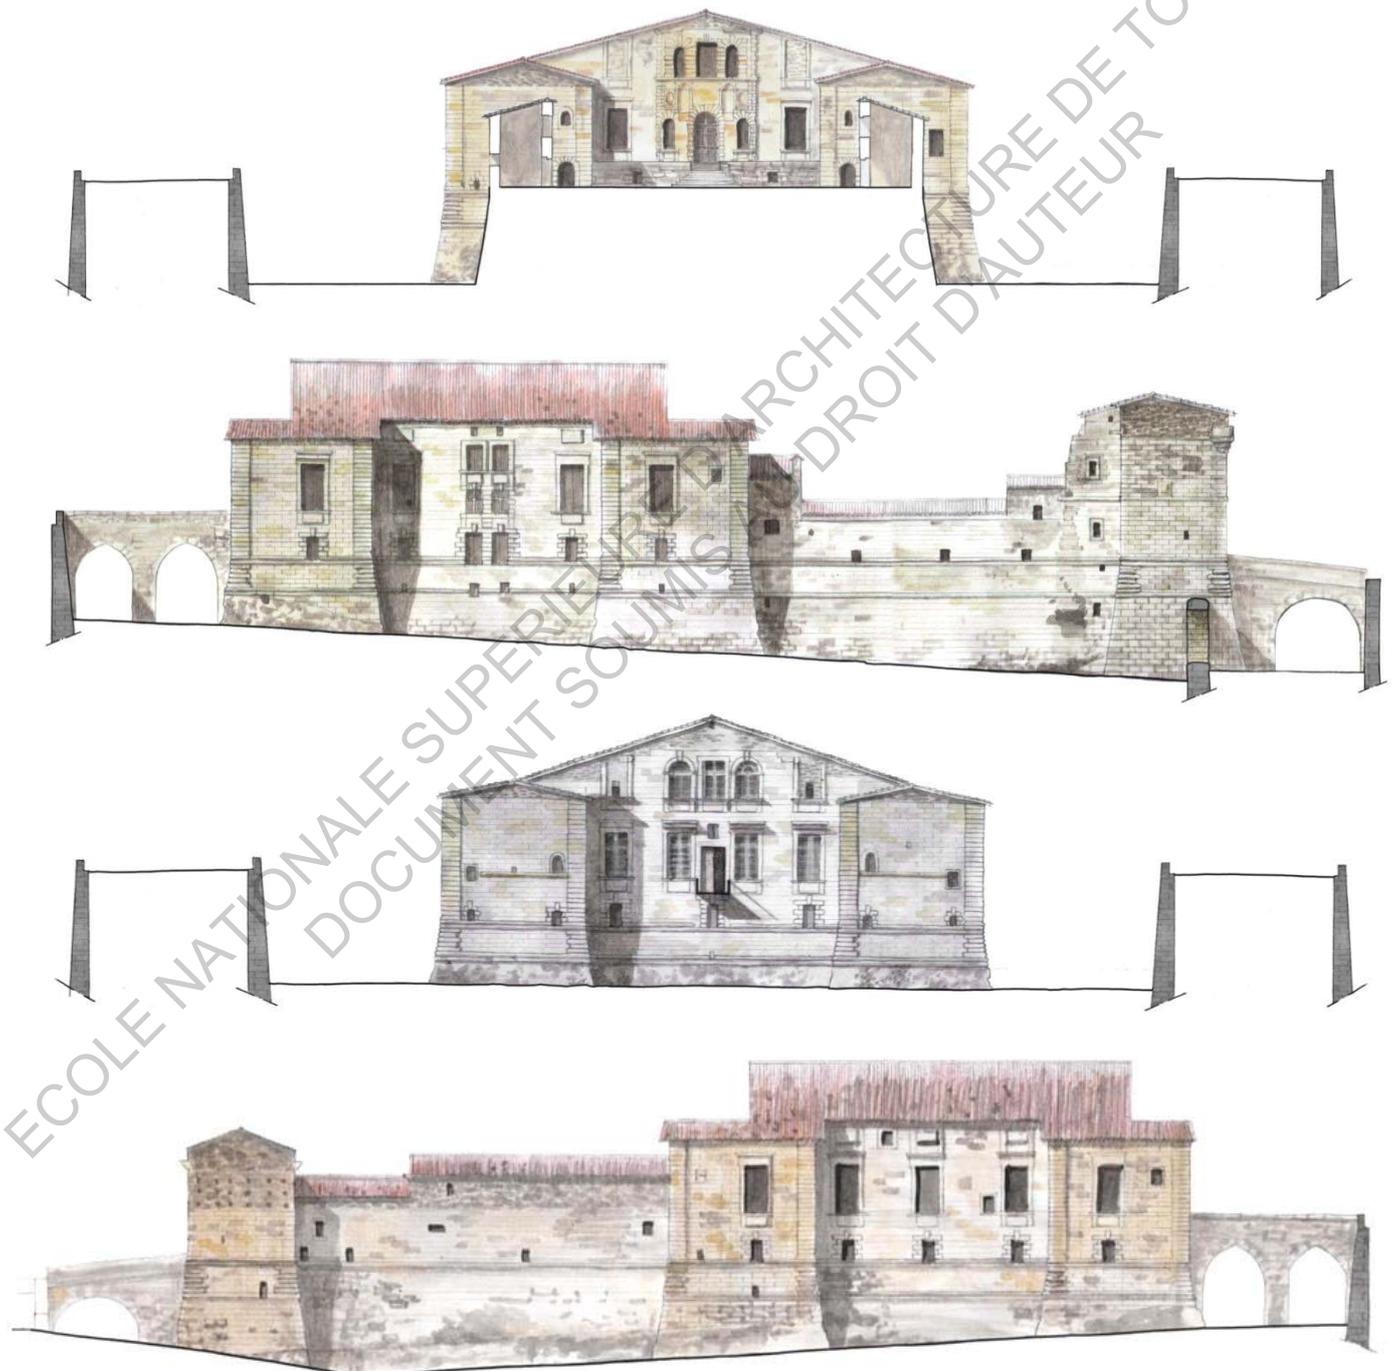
Façades du château. De haut en bas : façade Sud, façade Ouest, façade Nord, façade Est.
